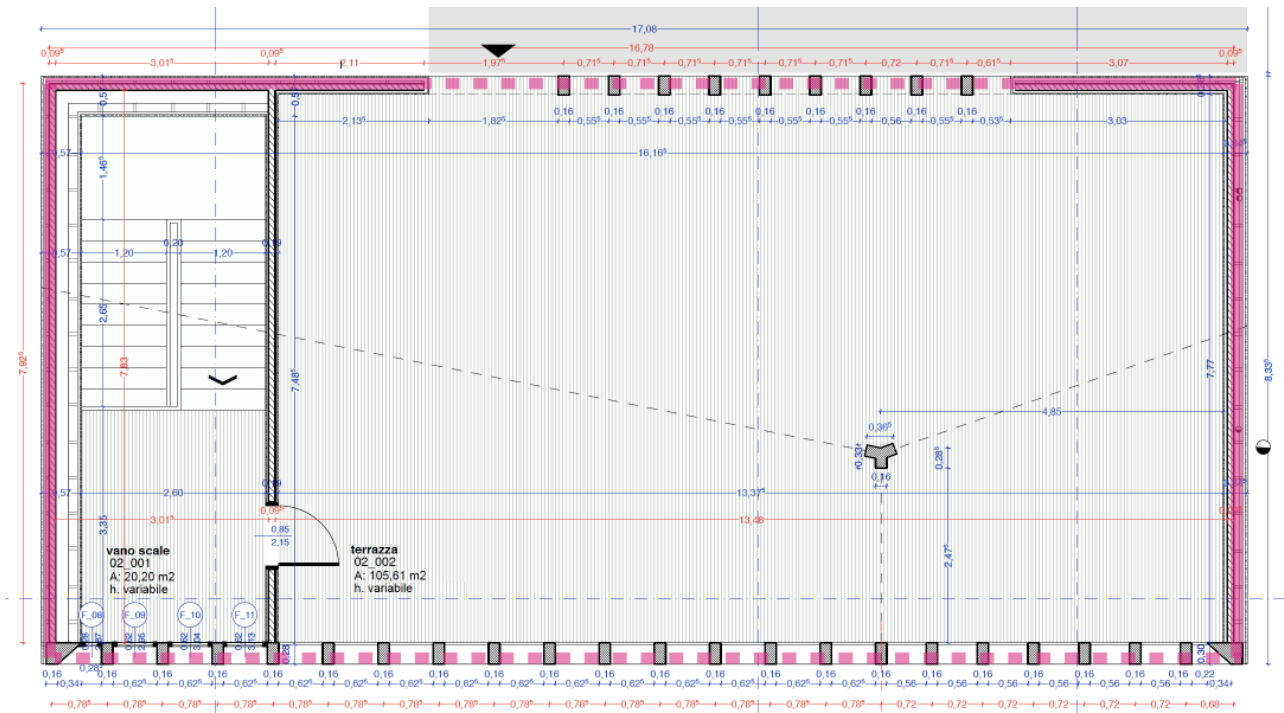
Pianta piano terra. Parete tipo 1 in Rosso, Parete tipo 2 in blu
